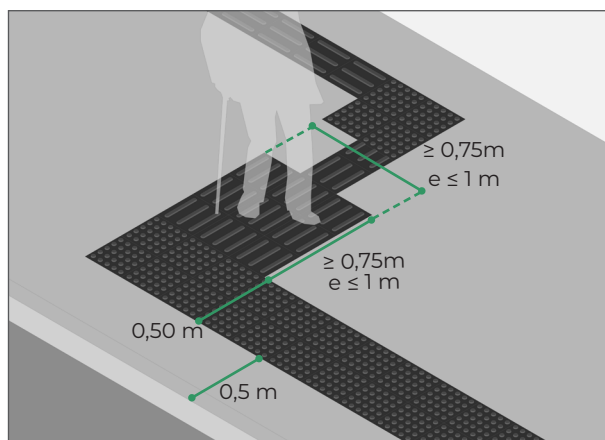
Dimensões da sinalização tátil de embarque e desembarque, com bloco direcional de 0,75 m a 1 m.
